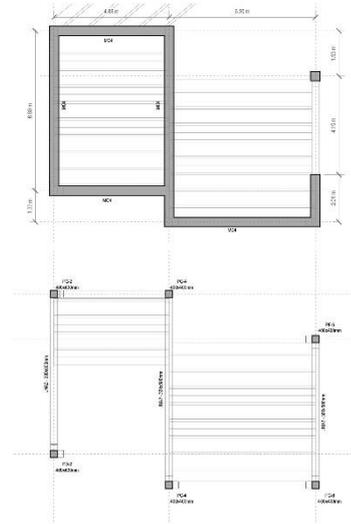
Axonometría Estructural - Techo Planta Baja y Primera - Alzado Sur
